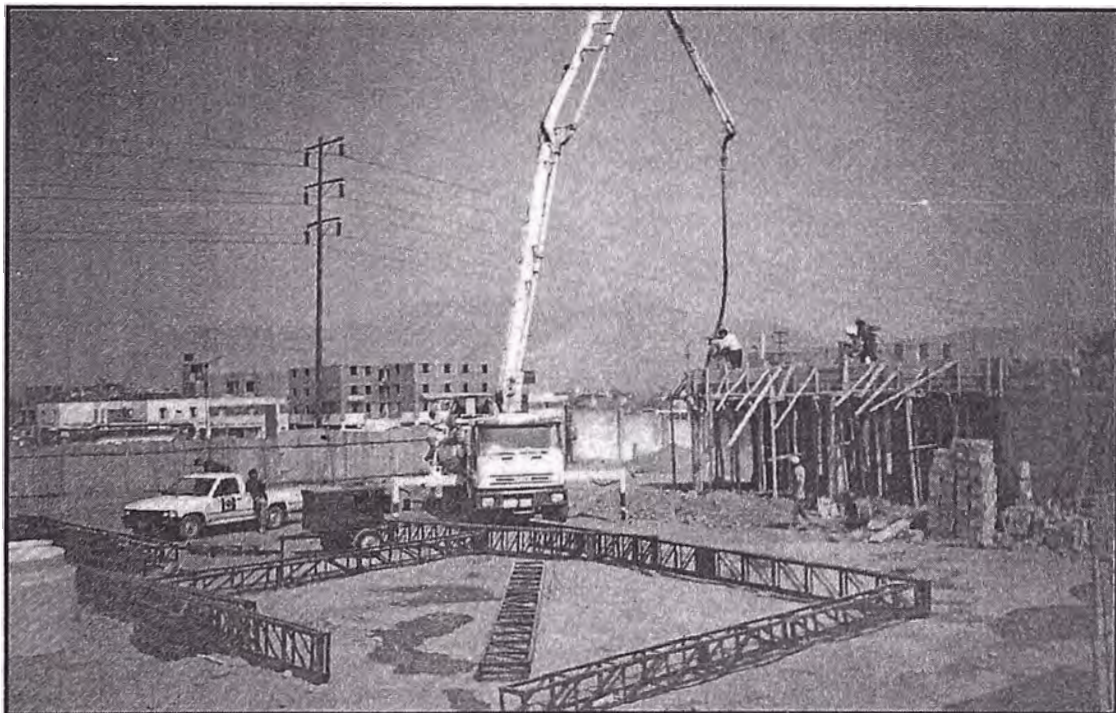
Vista general del llenado del Mobil Mart, además se observa la estructura metálica del techo del Canopy, que ha sido dejado en la zona de patio de maniobras, además el grupo electrógeno para la soldadura, y accesorios para el tanque
